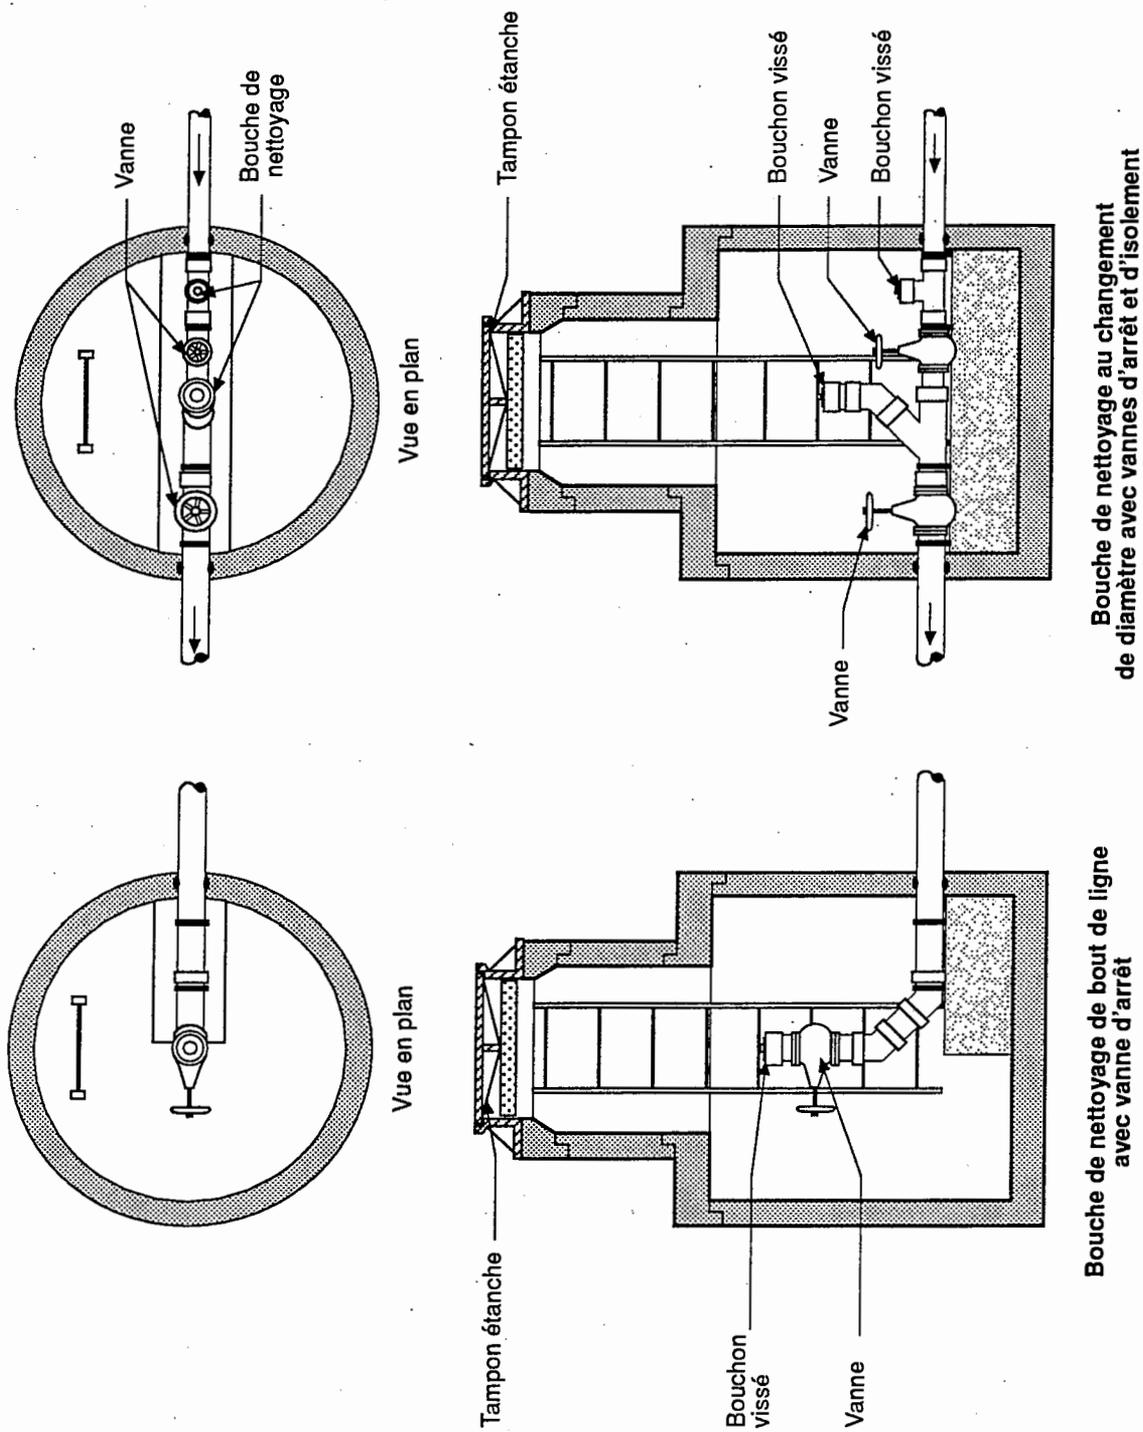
Un arrangement type de bouches de nettoyage et de vannes d'arrêt et d'isolement
